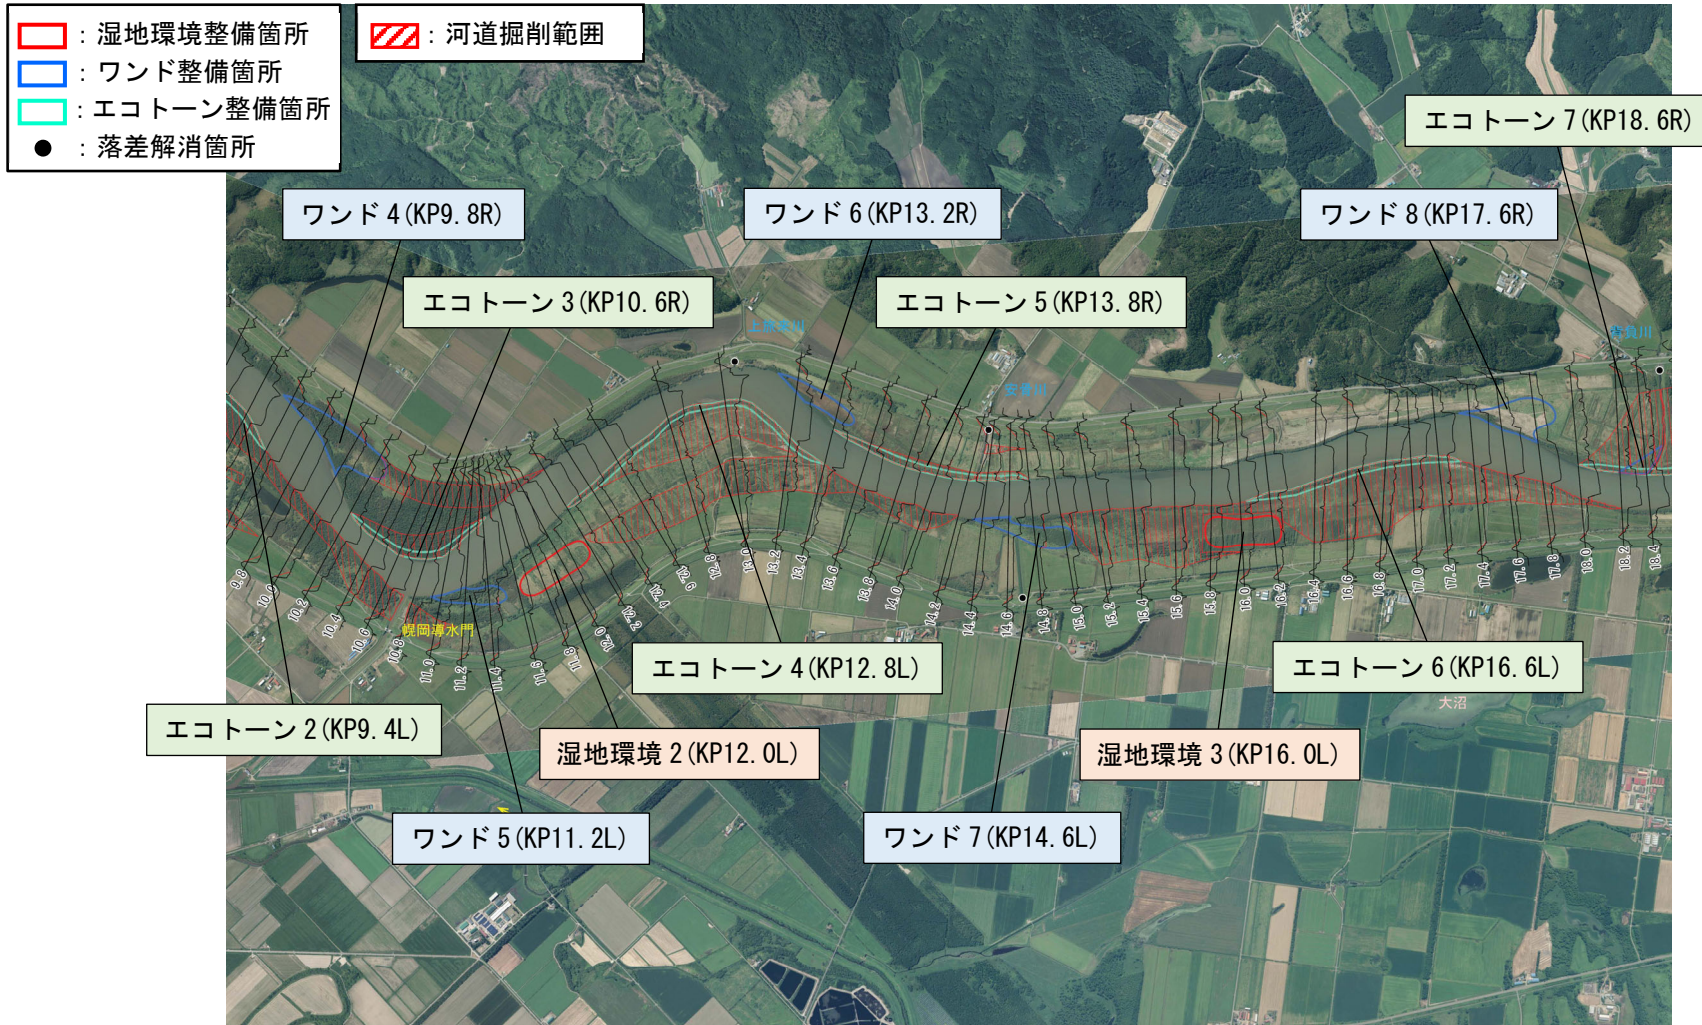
十勝川下流・中流部の配置計画平面図 (2/8)
